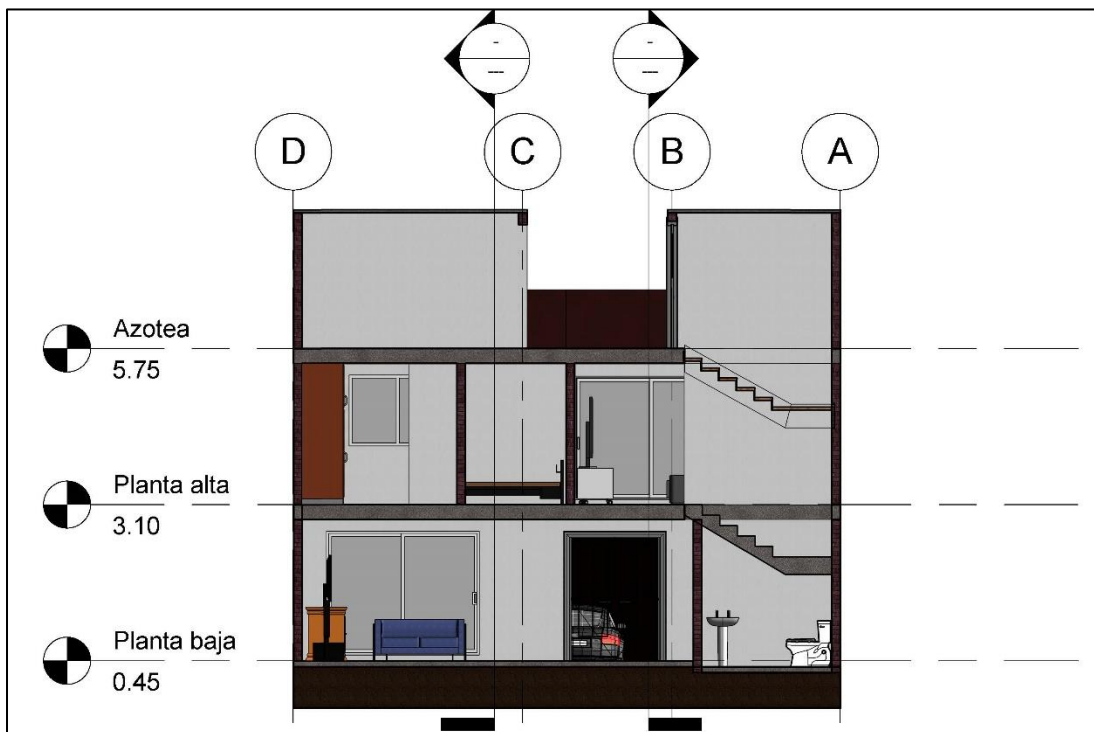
Plano de vivienda no sustentable: sección transversal 02. Fuente: autoría propia
